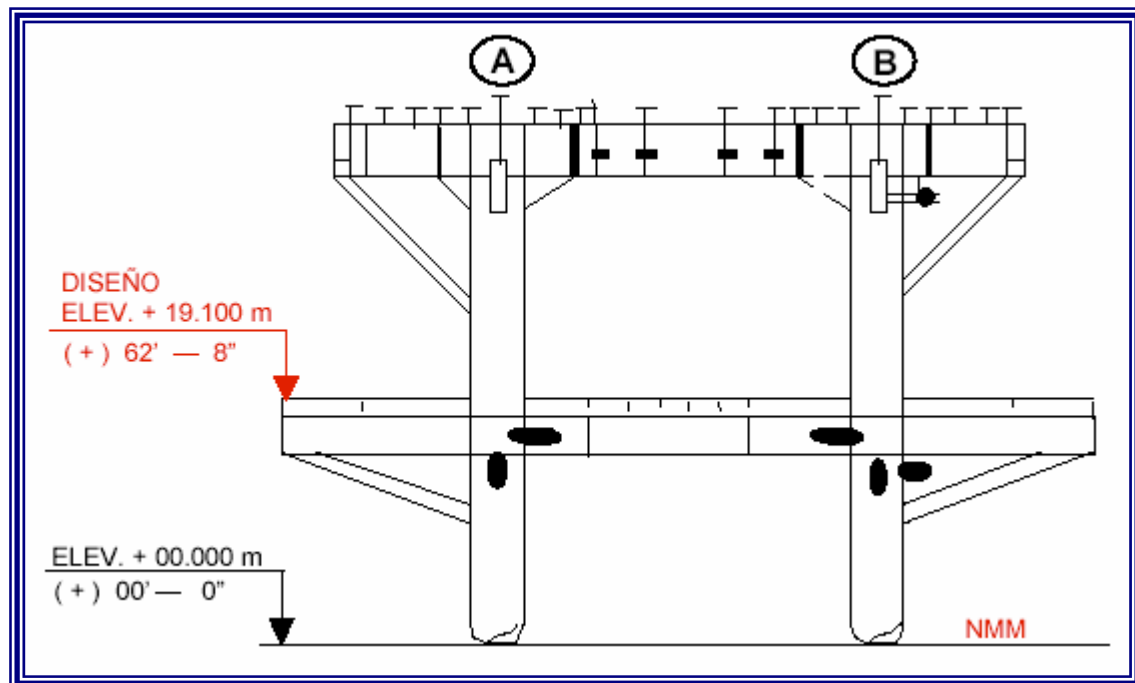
ELEVACIÓN MÍNIMA DE CUBIERTA INFERIOR.
